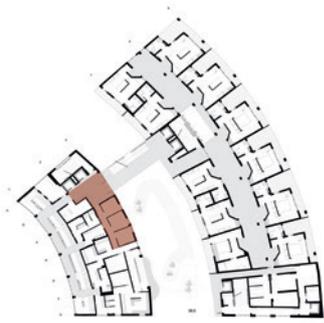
Planta Piso 2 | Localização das Salas de Tratamento
